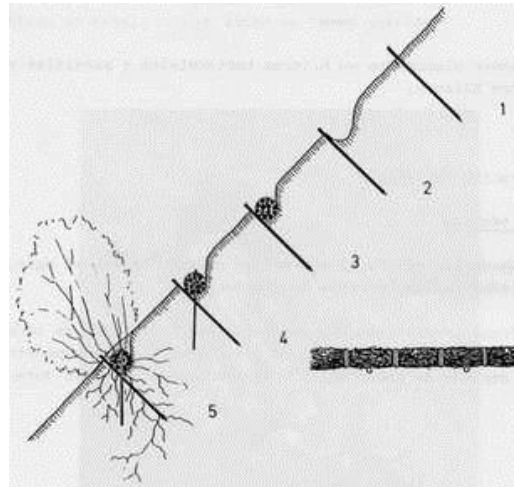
Construcción de empalizadas con fajinas de vegetación.
